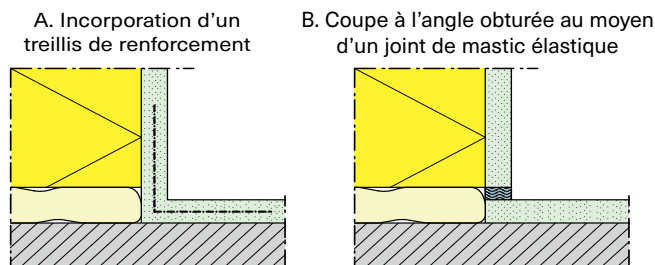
Raccord d'un enduit à une couche d'enduit fraîche.
